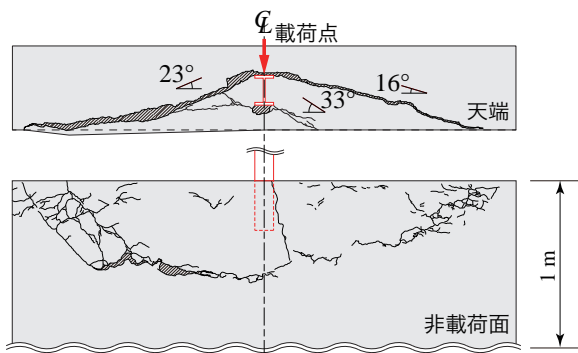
PS3-H2 試験体のひび割れ進展状況
